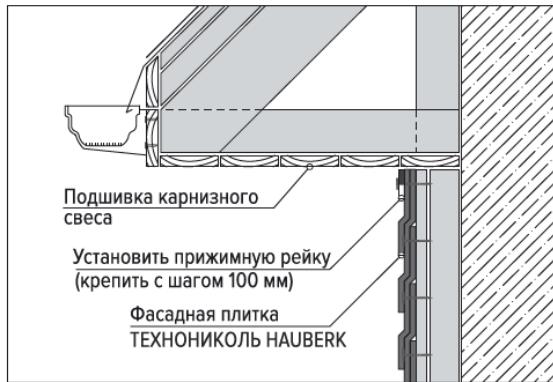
Монтаж верхнего ряда под карнизным свесом. Вариант 2
